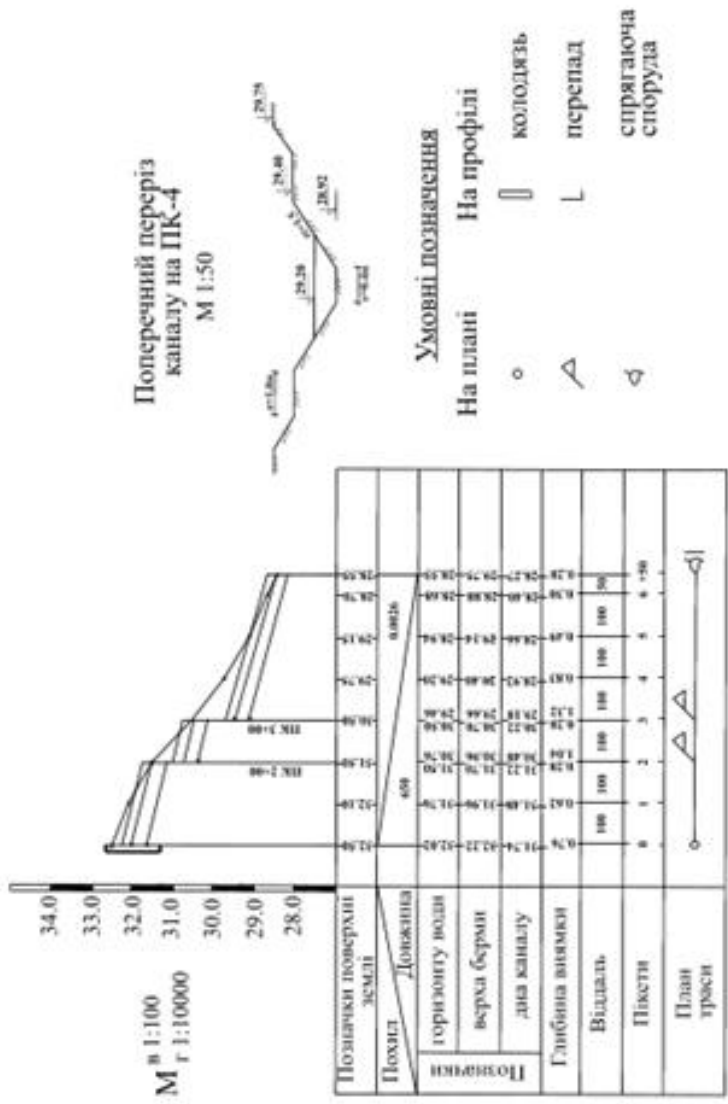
Поздовжній профіль водовідвідного каналу
